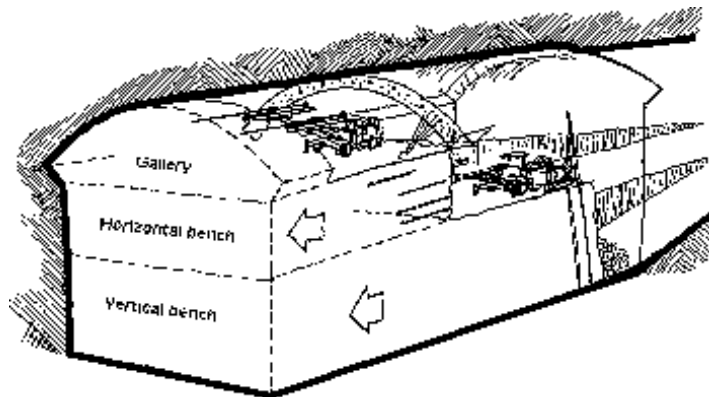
Sistema de Perforación con máquinas tuneladoras y de perforación. (LOPEZ JIMENO, 2000).¹²³
